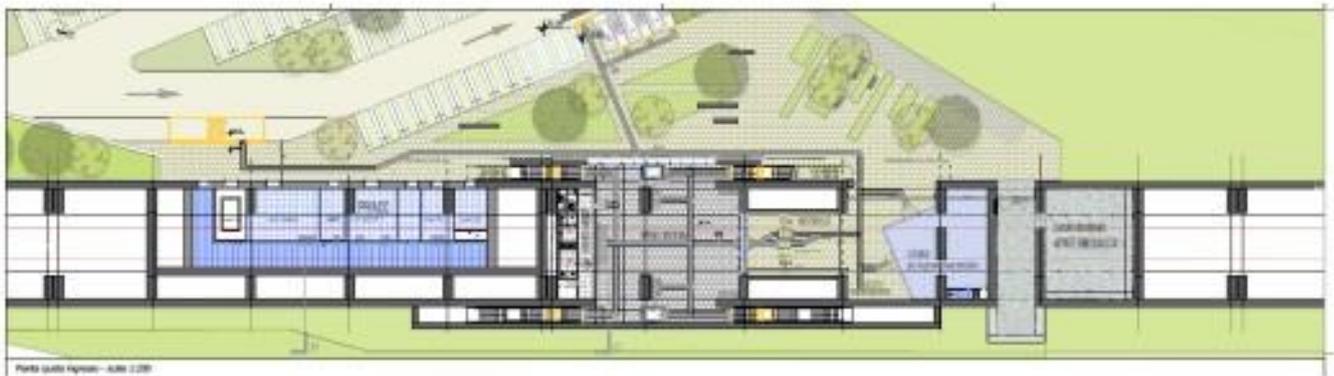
Layout Stazione quota ingresso (Interno opera scatolare)
